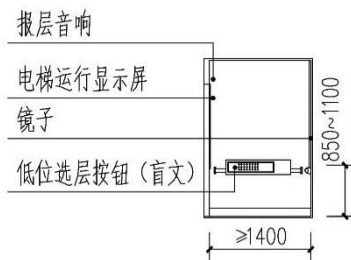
无障碍电梯轿厢侧立面示意图
